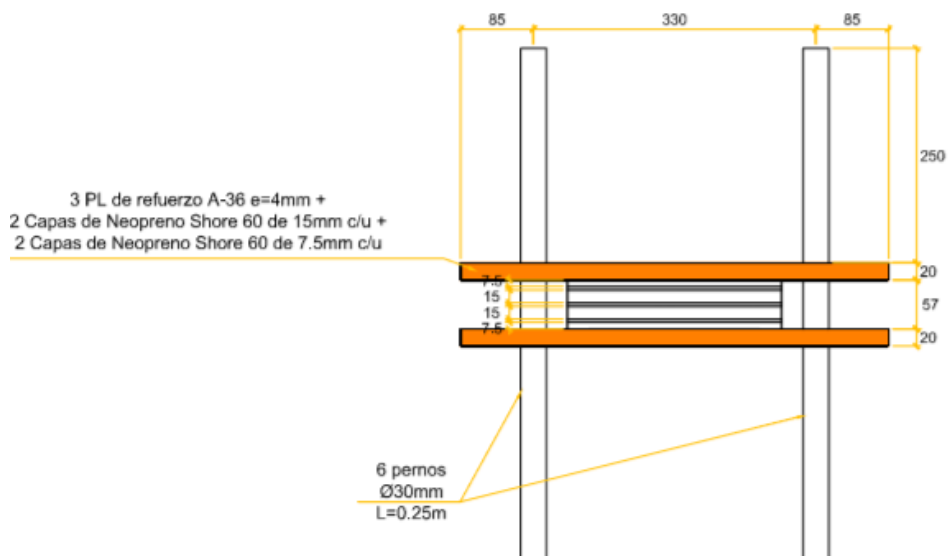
Vista longitudinal vinculación entre pilar intermedio y tablero
